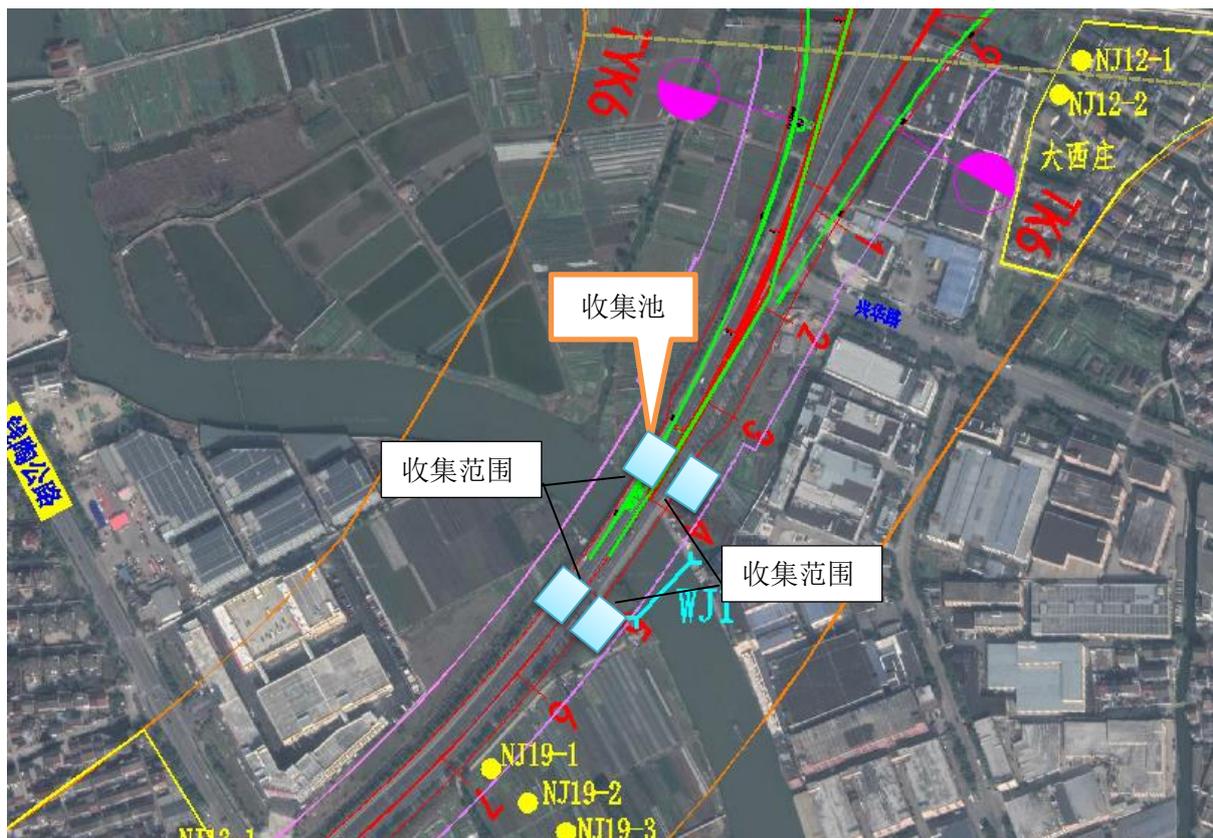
项目湖安路高架主线桥 1 跨越东小江收集系统平面布置图
